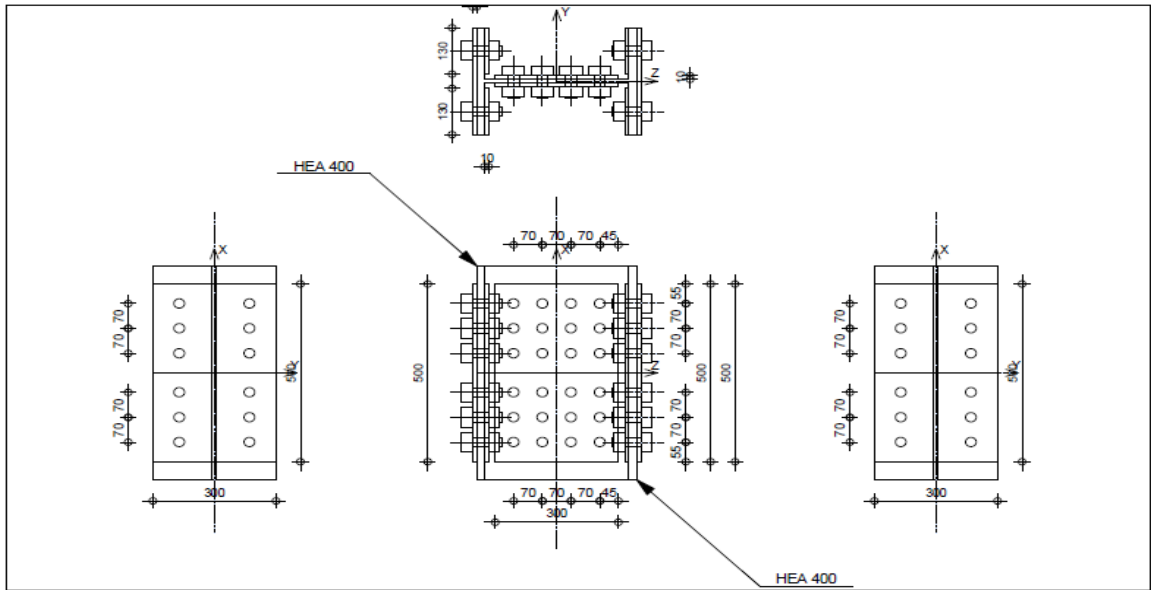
Schéma d'assemblage poteau – poteau.
